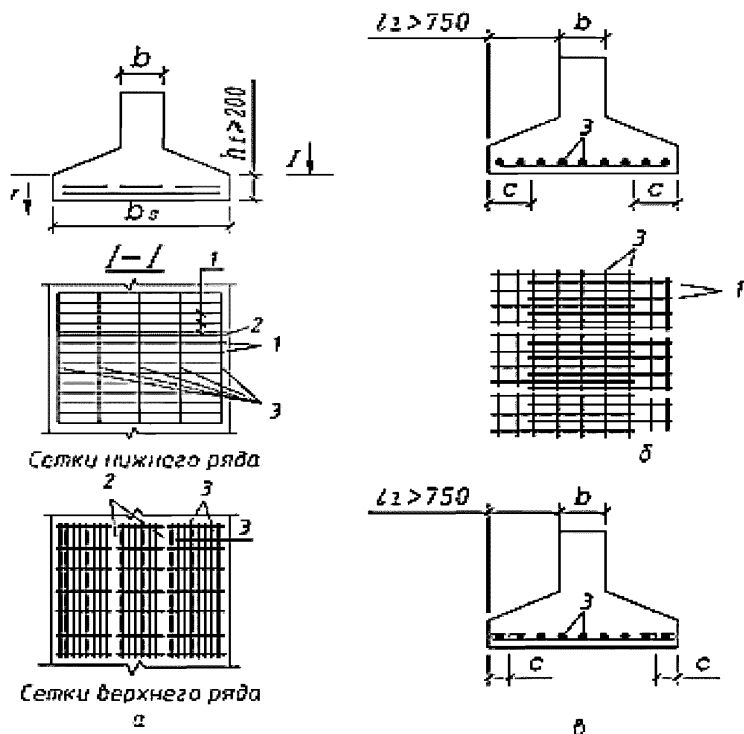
Армирование плит ленточных фундаментов сетками:
